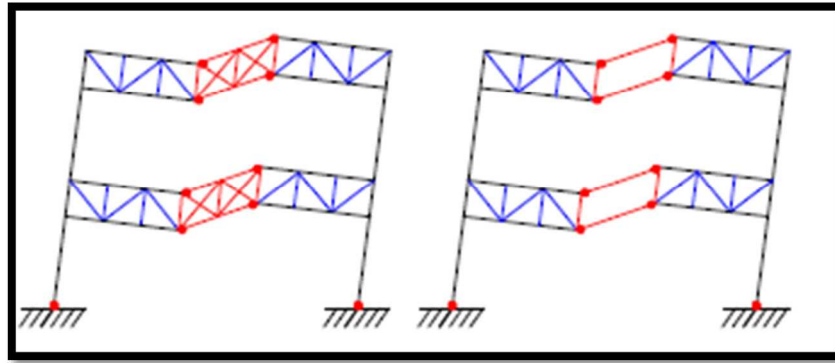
Pórtico no arriostrado con vigas reticuladas,
